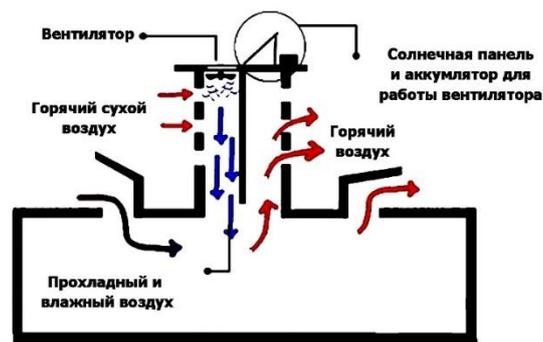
Схема увлажнения воздуха внутри здания с использованием вентилятора в ветровой башне
